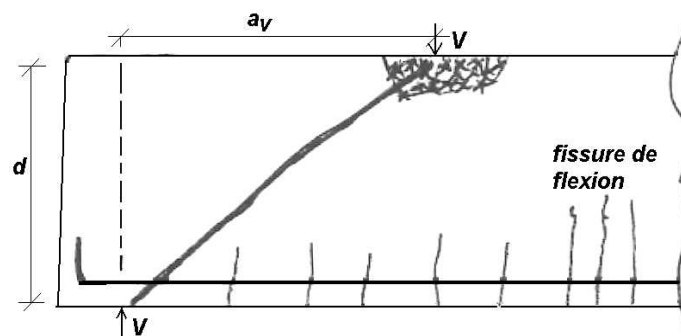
Etat de fissuration à la rupture d'une poutre avec  $(1 < a/d < 2.5)$  [10]
